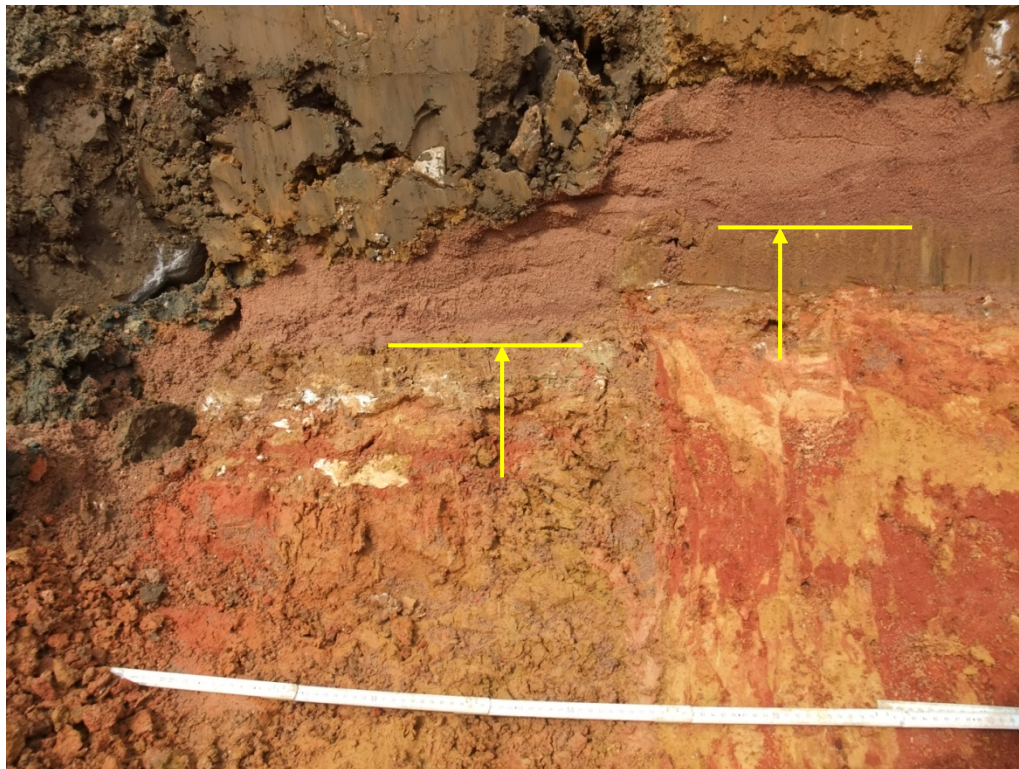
Aushub -1,9 m, nördlicher Rand Einbruchtrichter 1: Detail zu Bild 23 mit Versatz in Filtersand und anschließender sandgefüllter Spalte in kreidezeitlichen Sedimenten
